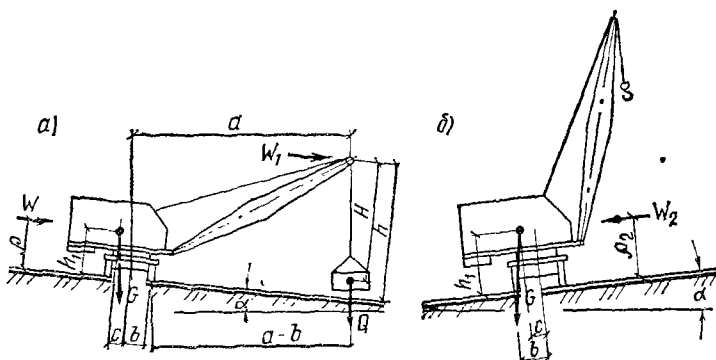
Схемы крана к расчету устойчивости: грузовой (а); собственной (б)
